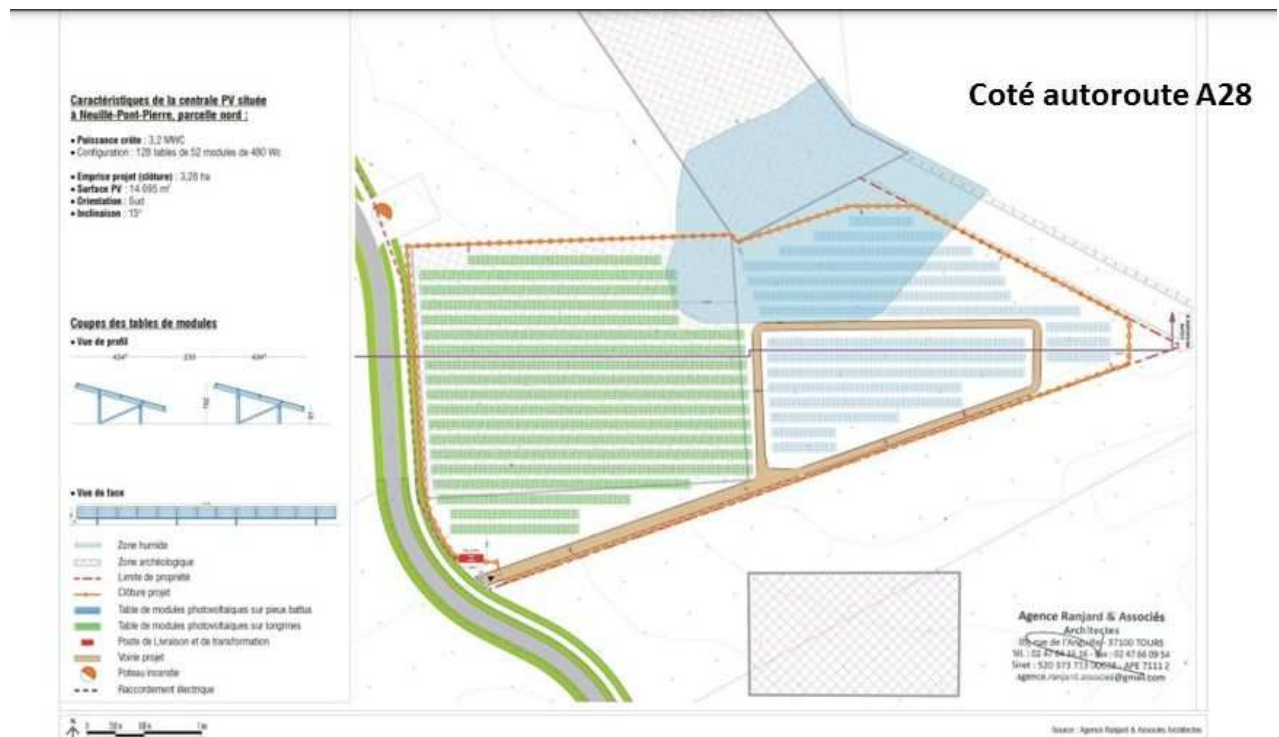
Plan masse du projet de centrale photovoltaïque de Neuillé-Pont-Pierre
